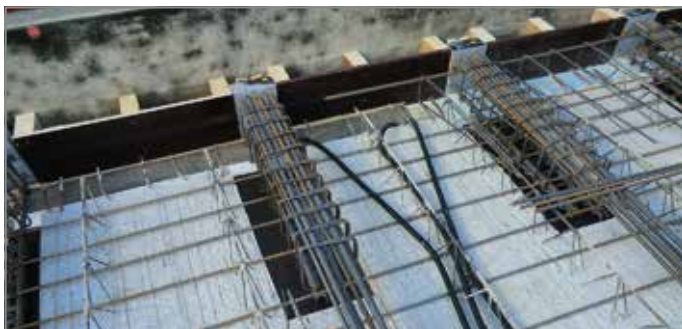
Aussparung im Halbfertigteil bei Verwendung des Schöck Isokorb® T/XT Typ SK-MM1-VV1, SK-MM2-VV1
